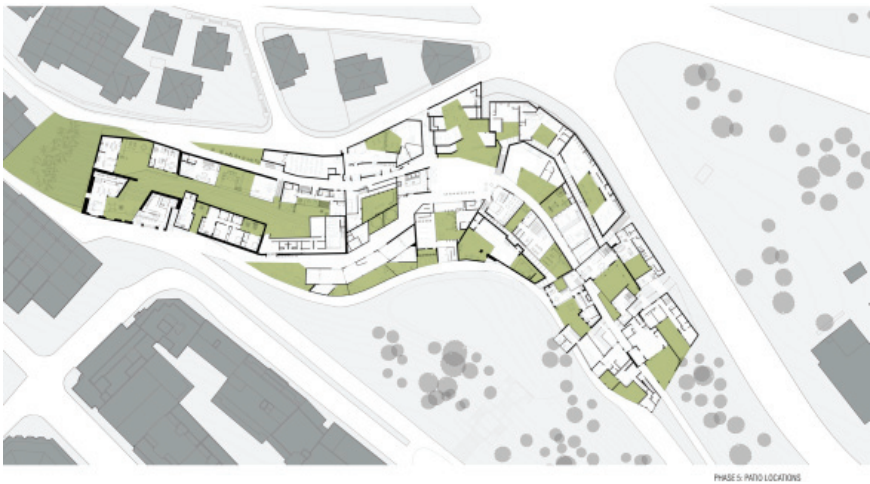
Plano "Nolli" del barrio a nivel de las plantas bajas (los patios en verde)
